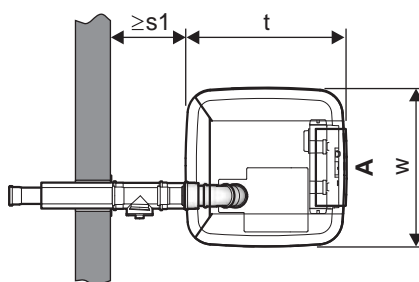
Vista dall'alto GCU compact raccordo fumi verso il retro con SET H (v. sezione 4.5.3) - (dimensioni v. tab. 4-1)
